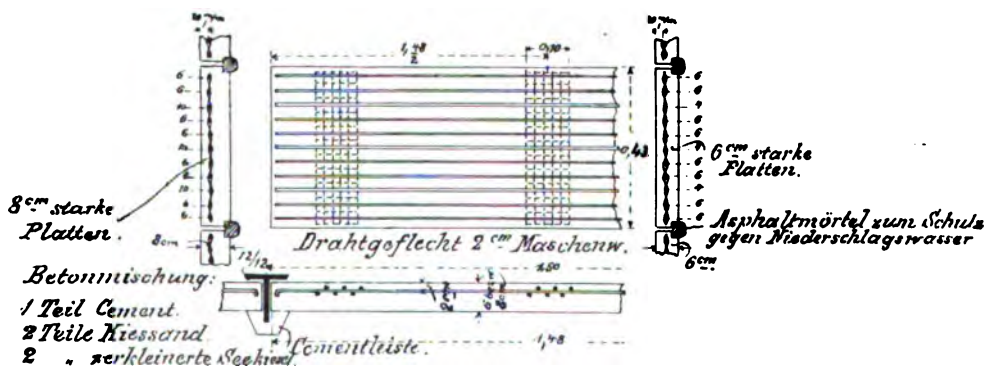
Eisenbetonplatten am Fischmarkt in Danzig.
